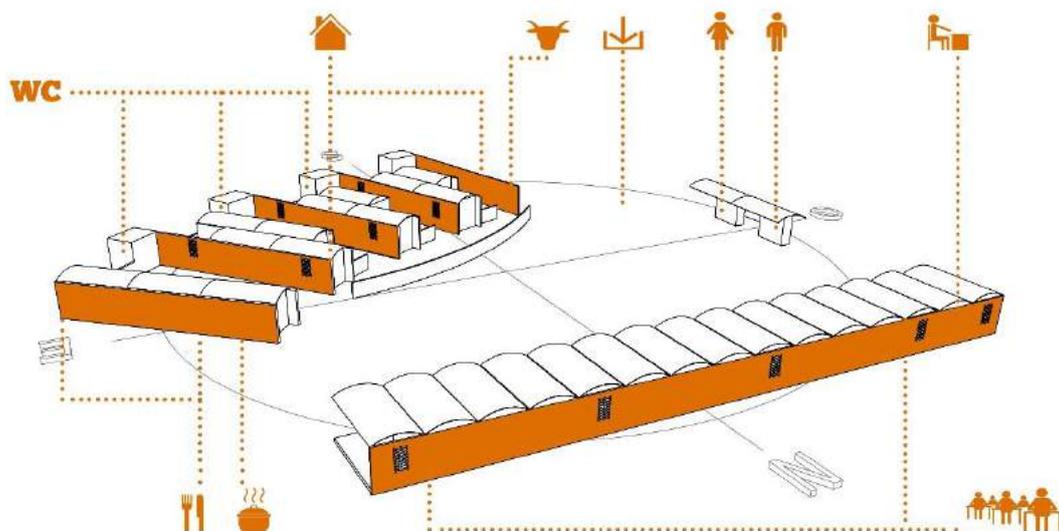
Axonometría conjunto. Fuente: Elaboración propia
